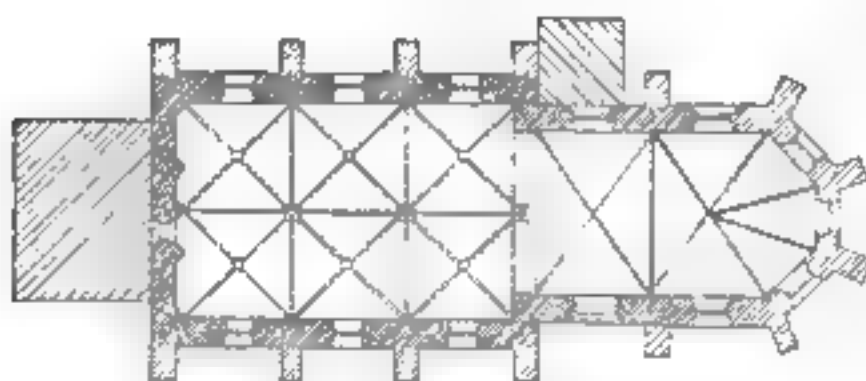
Grundriss der Kirche zu Hütten
